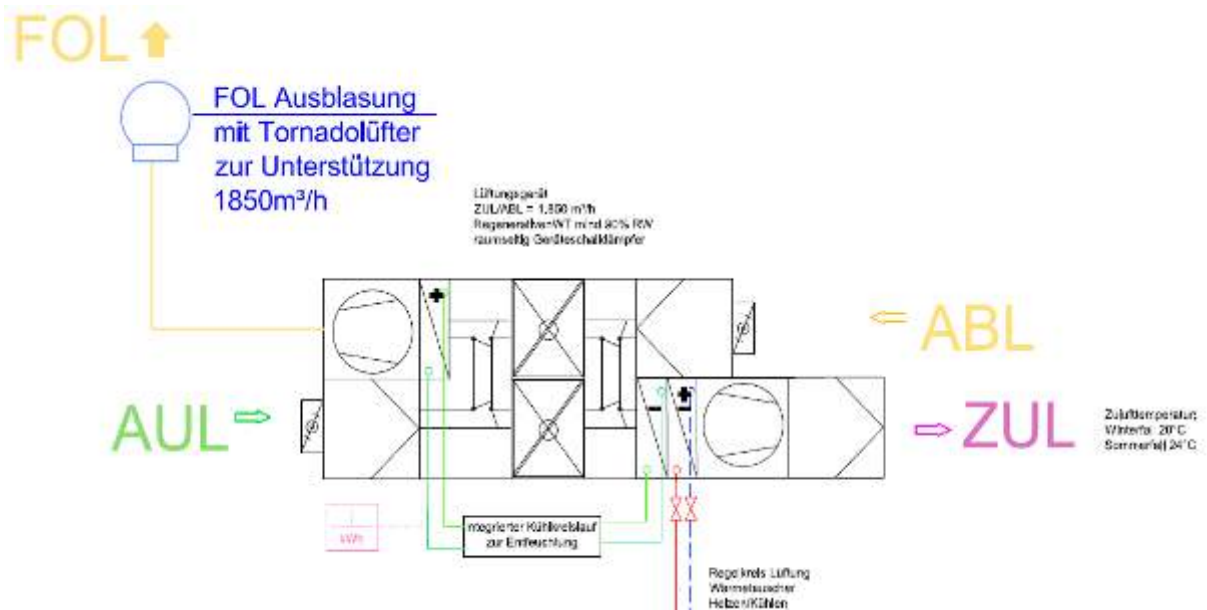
Anlagenschema Lüftungsanlage mit Tornadolüfter
